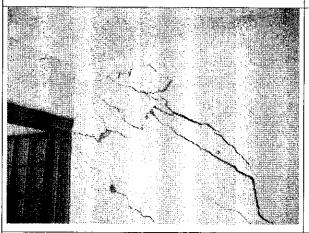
Agrietamientos en muro de segundo piso.
